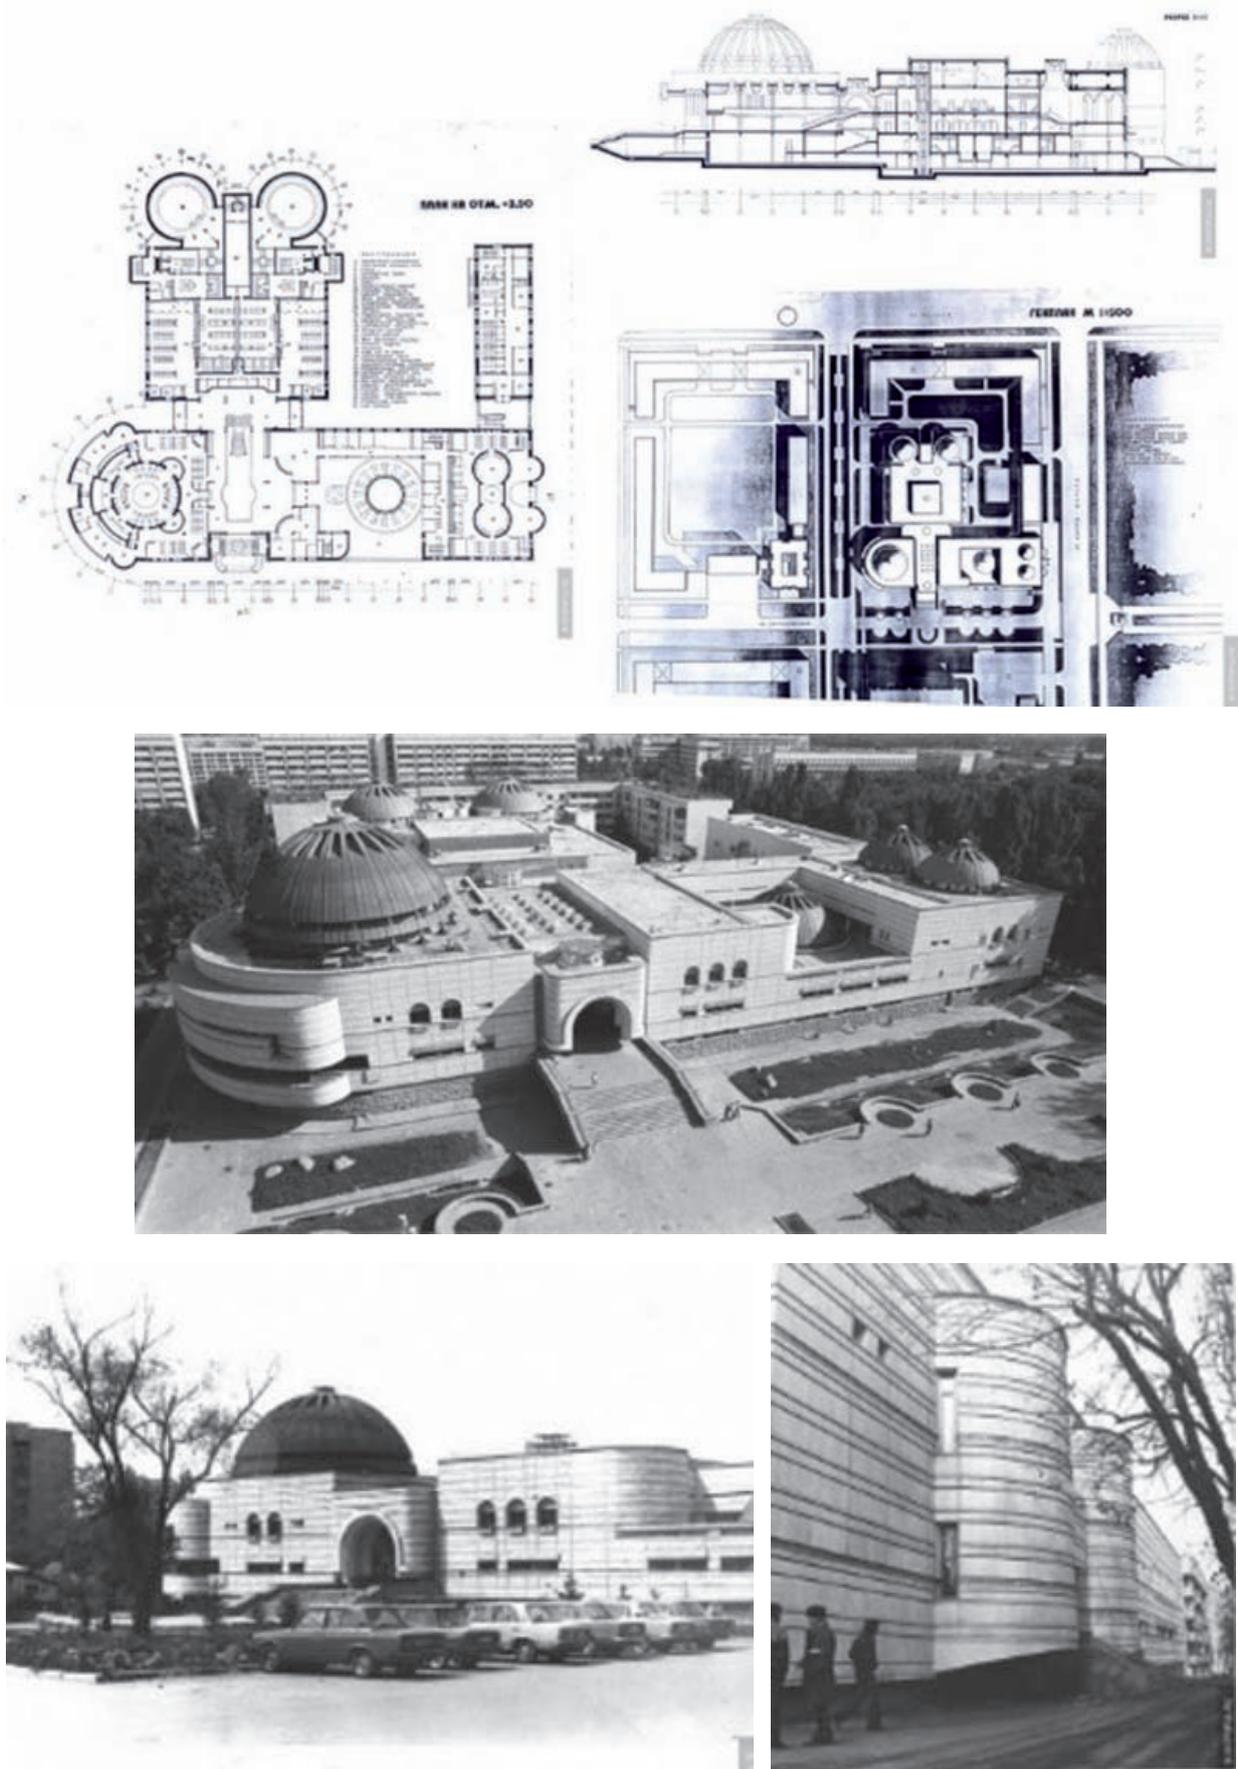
Лечебно-оздоровительный комплекс «Арасан» (план, разрез, генплан, фасады)
